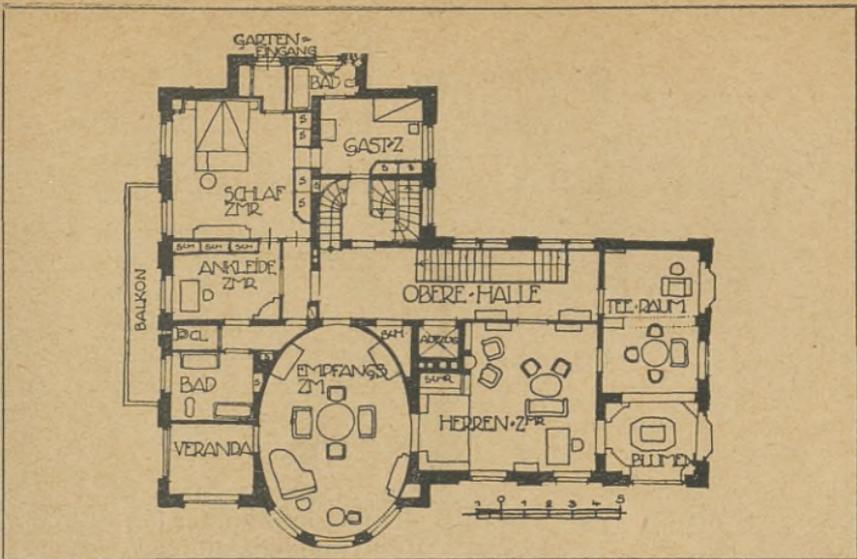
Größeres Haus mit langrundem Empfangszimmer
